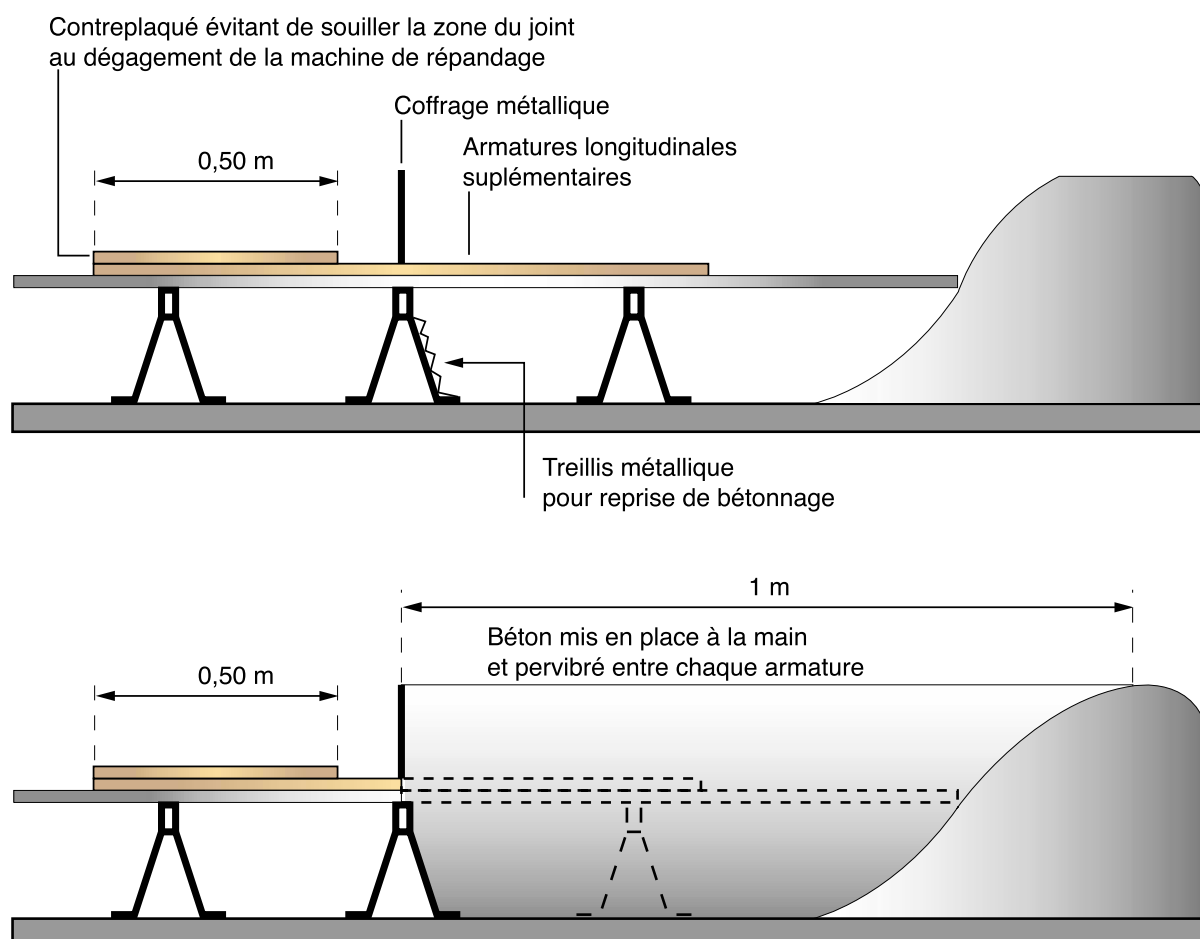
dispositif de réalisation d'un joint transversal de construction
